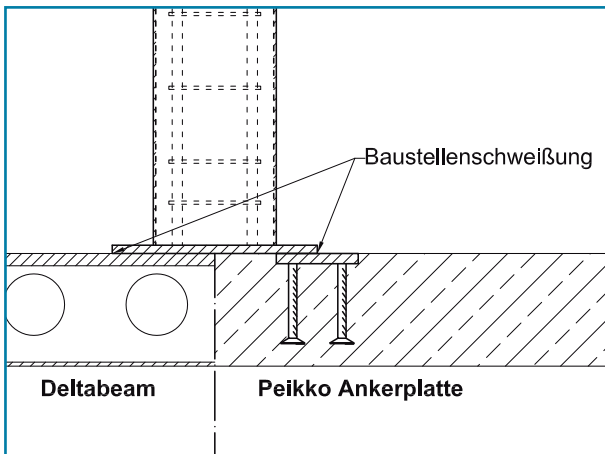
Anschlusspunkt Fußplatte geschweißt
